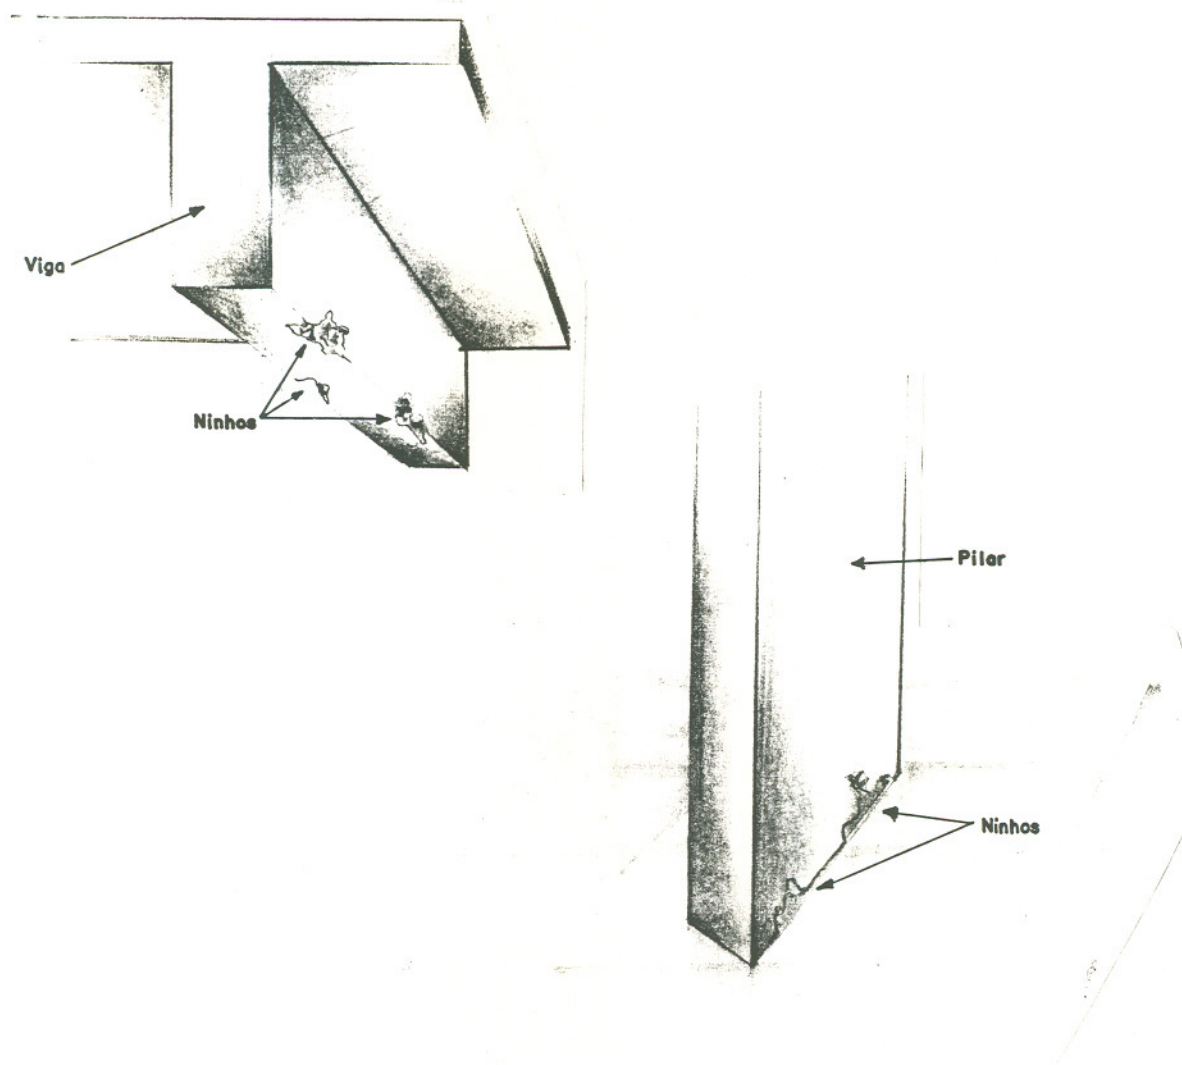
Ocorrência de ninhos de concretagem em vigas e pilares - locais mais frequentes.
